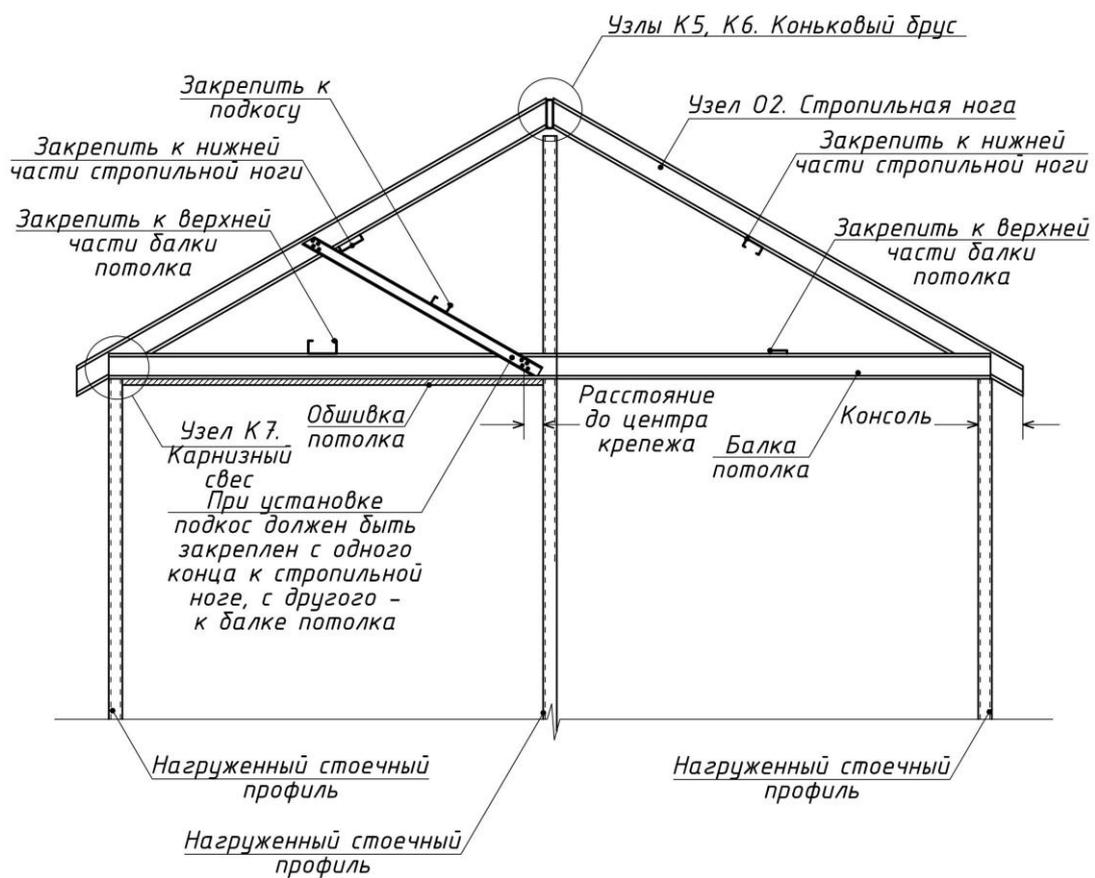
Узел К 1. Типовая схема стропильной конструкции крыши
